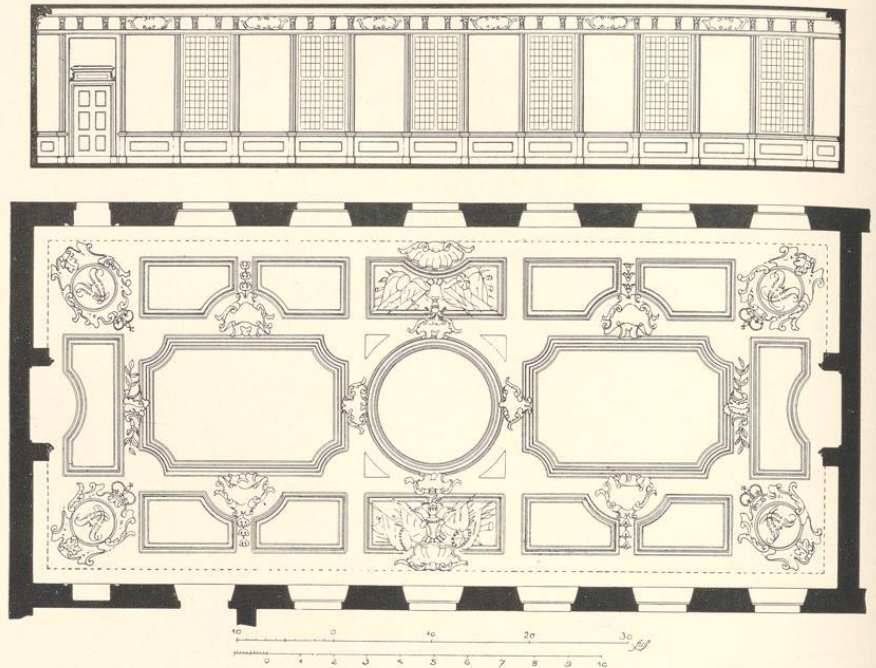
Grundriß des Hofsaales mit Einzeichnung der Stuckdecke und Aufriß der Südwand
